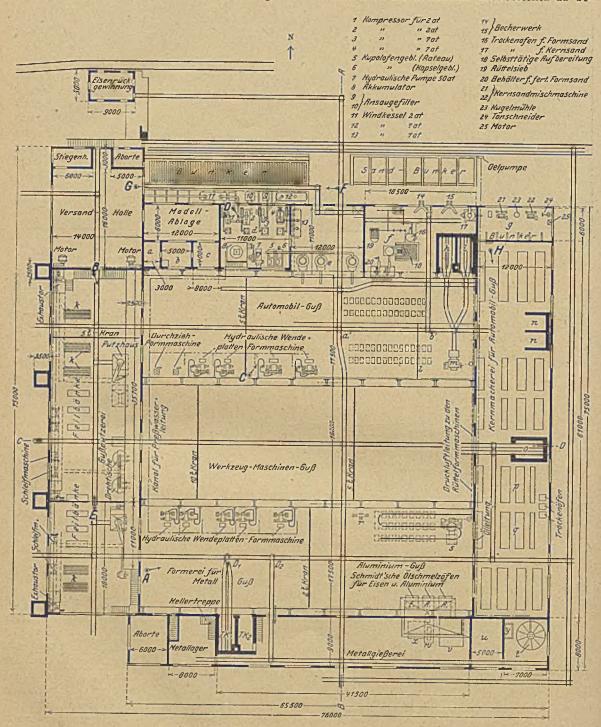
Grundrisse der gesamten Gießereianlage.
